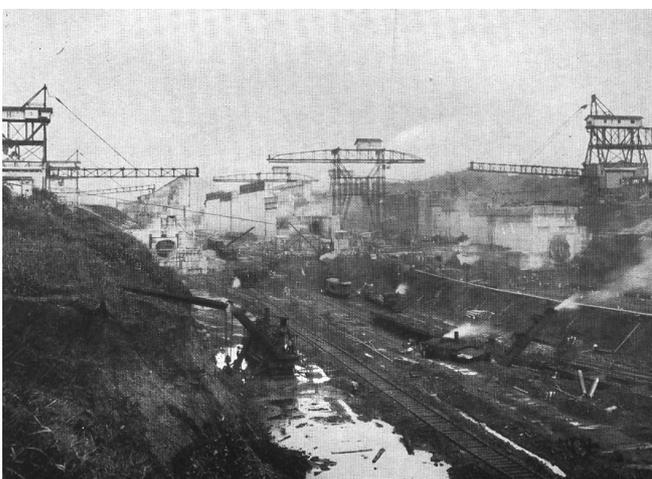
“Actividades de la construcción” que modificaban constantemente la topografía.
